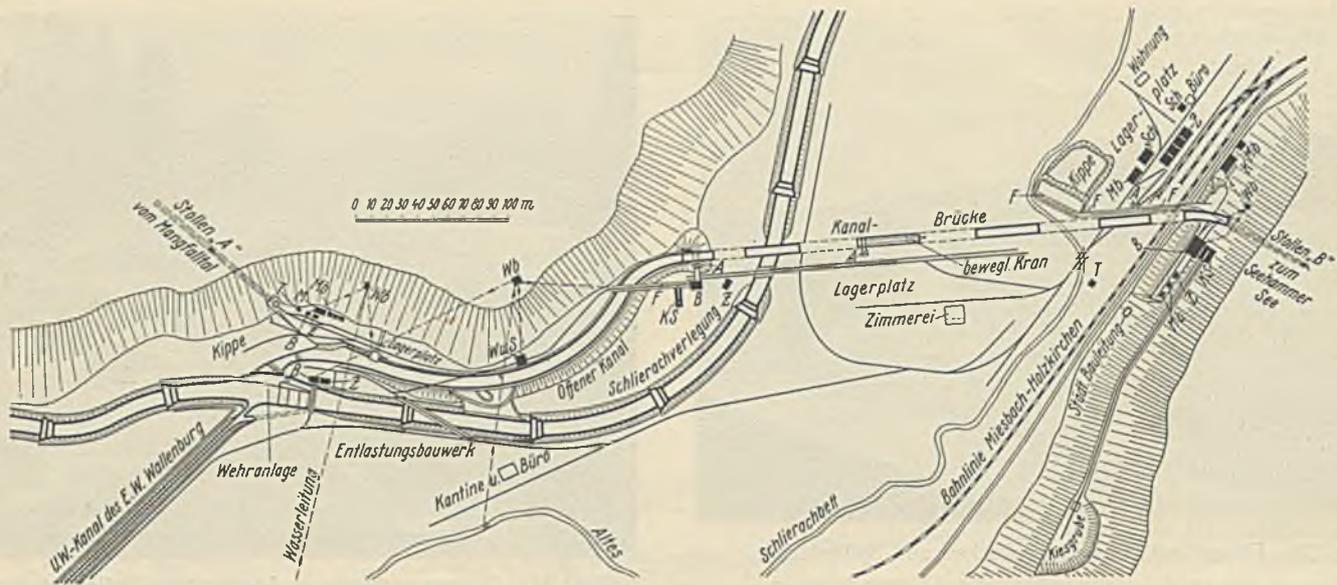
Baustelleneinrichtung im Schlierachtal.
